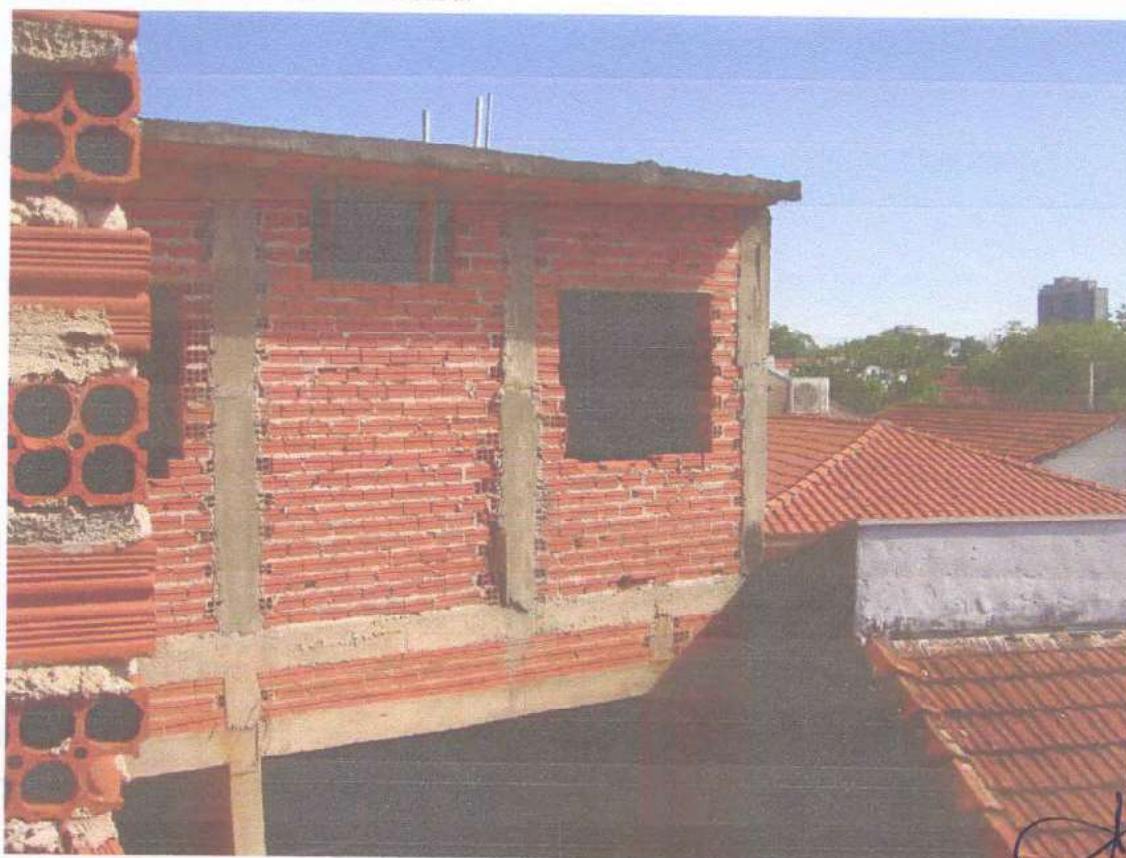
Vista da parte superior onde verificamos a falta de cobertura da obra (telhado).
